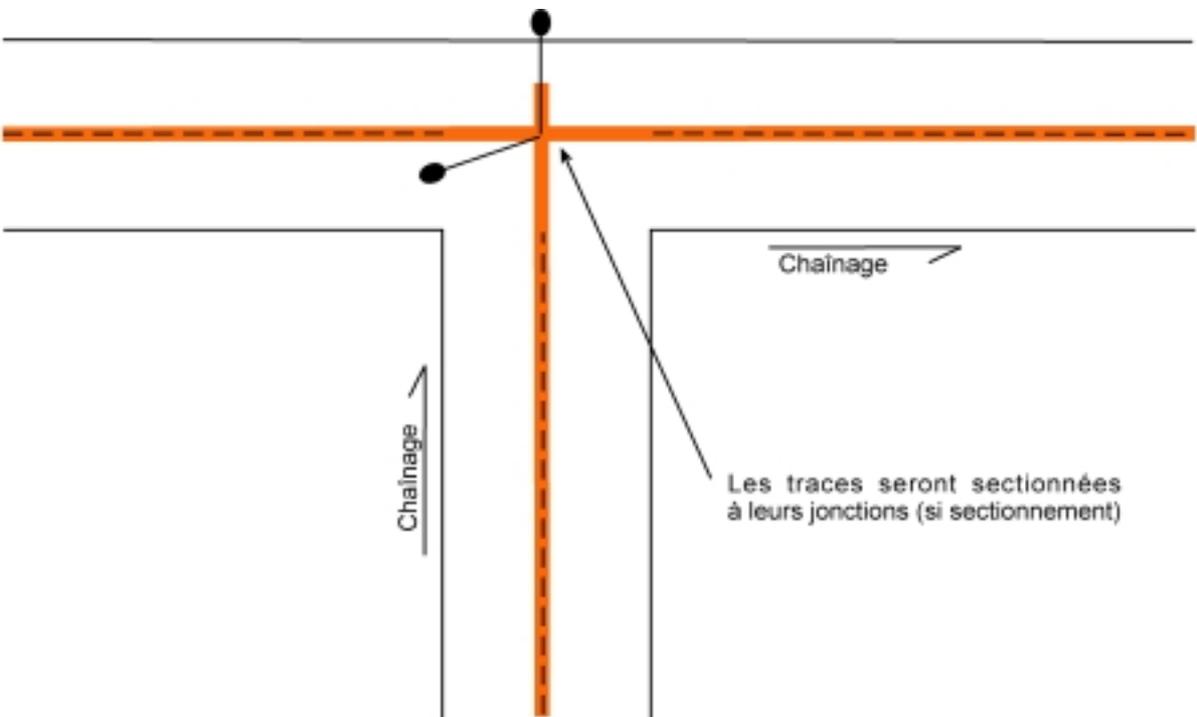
Trace dont le sectionnement se fait à une intersection en « T » (une sous-route contiguë sectionnée à l'intersection de chaussées séparées)
